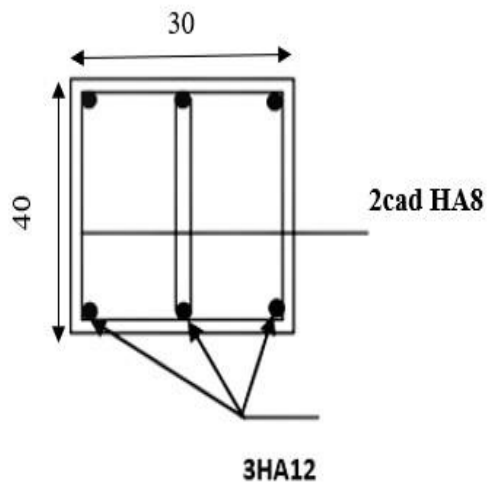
Schéma de Ferrailage de la poutre palière :
